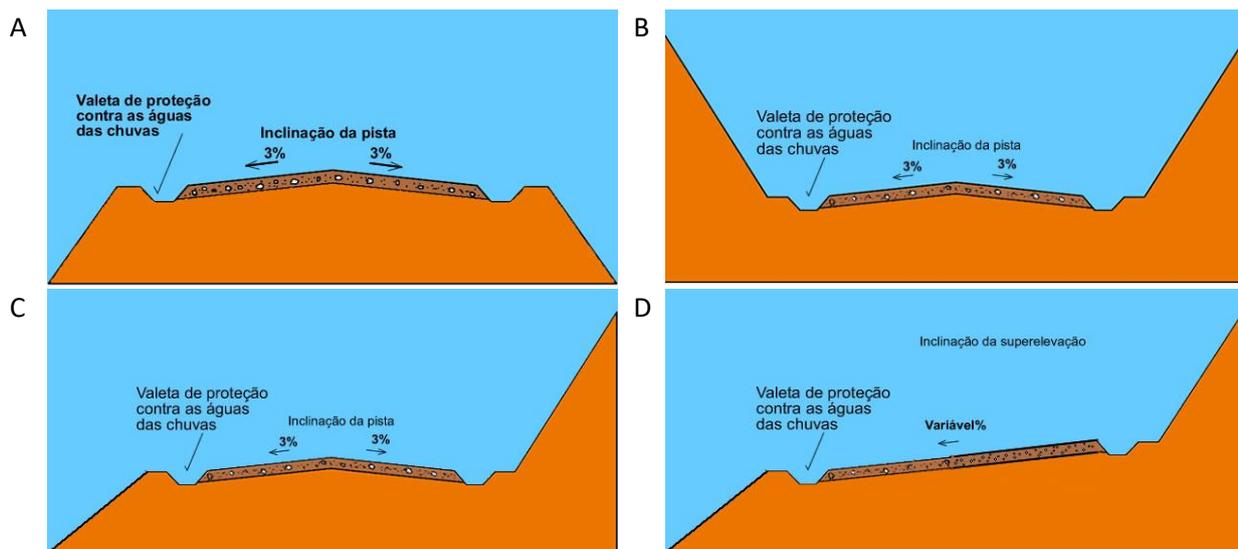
Seções transversais típicas. A. Seção transversal de aterro em tangente; B. Seção transversal de corte em tangente; C. Seção transversal mista em tangente; D. Seção transversal mista em curva.
